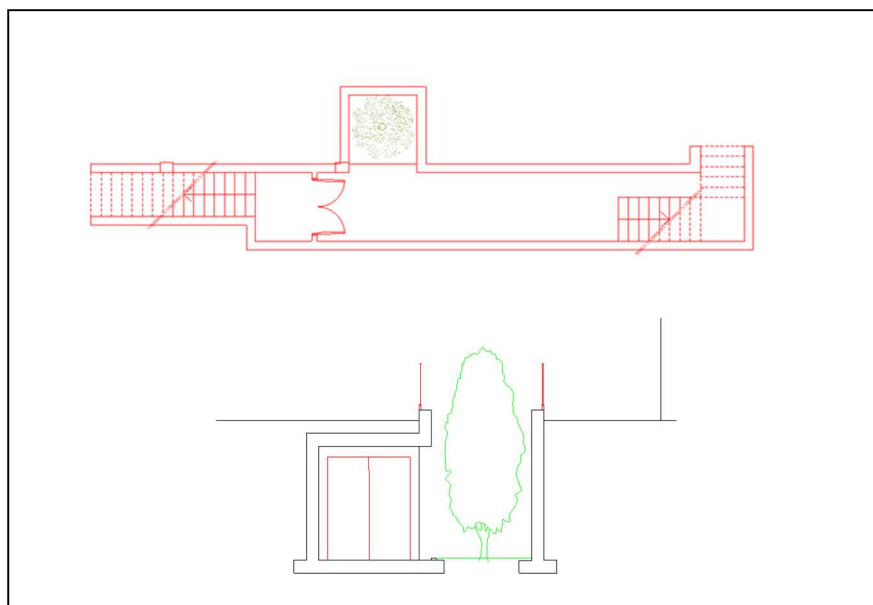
Planta e corte do túnel do projeto arquitetura
